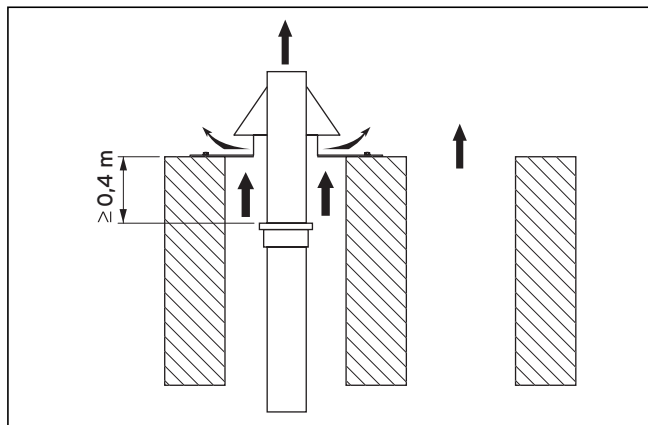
Высота дымовой трубы над выпускным газопроводом из ПП с устьем из нержавеющей стали - с забором воздуха из помещения
